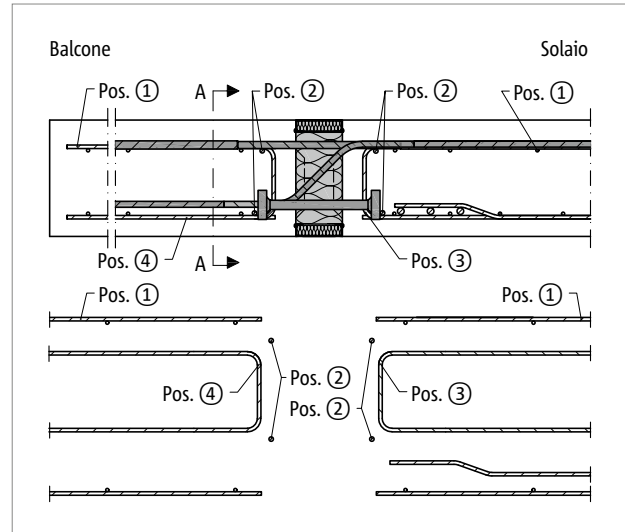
Schöck Isokorb® T tipo K-M12: armatura in opera con appoggio indiretto
